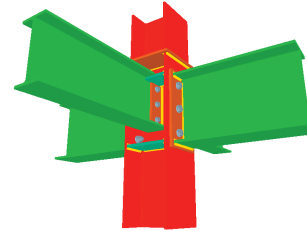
Unione bullonata di due travi incastrate alle ali del pilastro mediante lamiere frontali e di due travi ortogonali incernierate mediante lamiere laterali (in corrispondenza della transizione dei pilastri)
